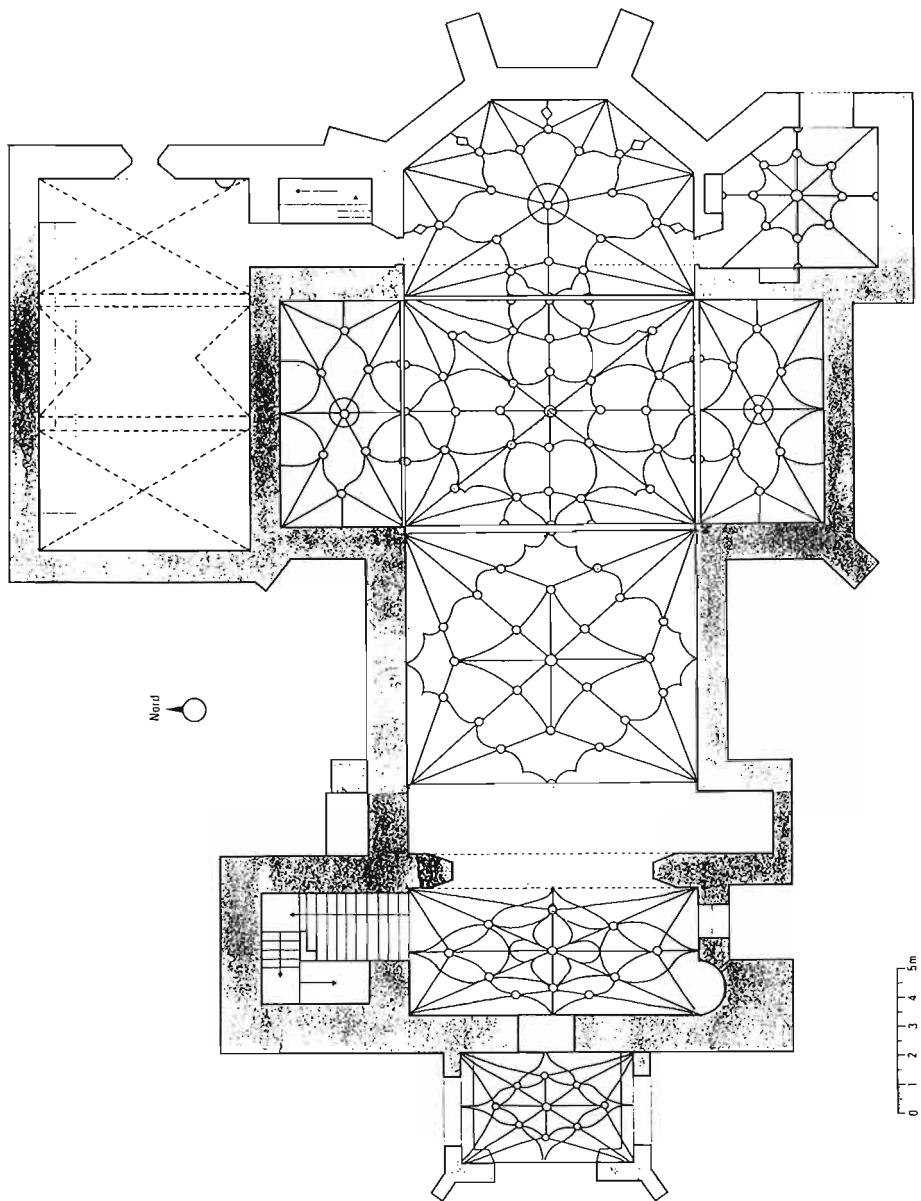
San Pedro de Ansó. Planta con la traza de las nervaduras.
